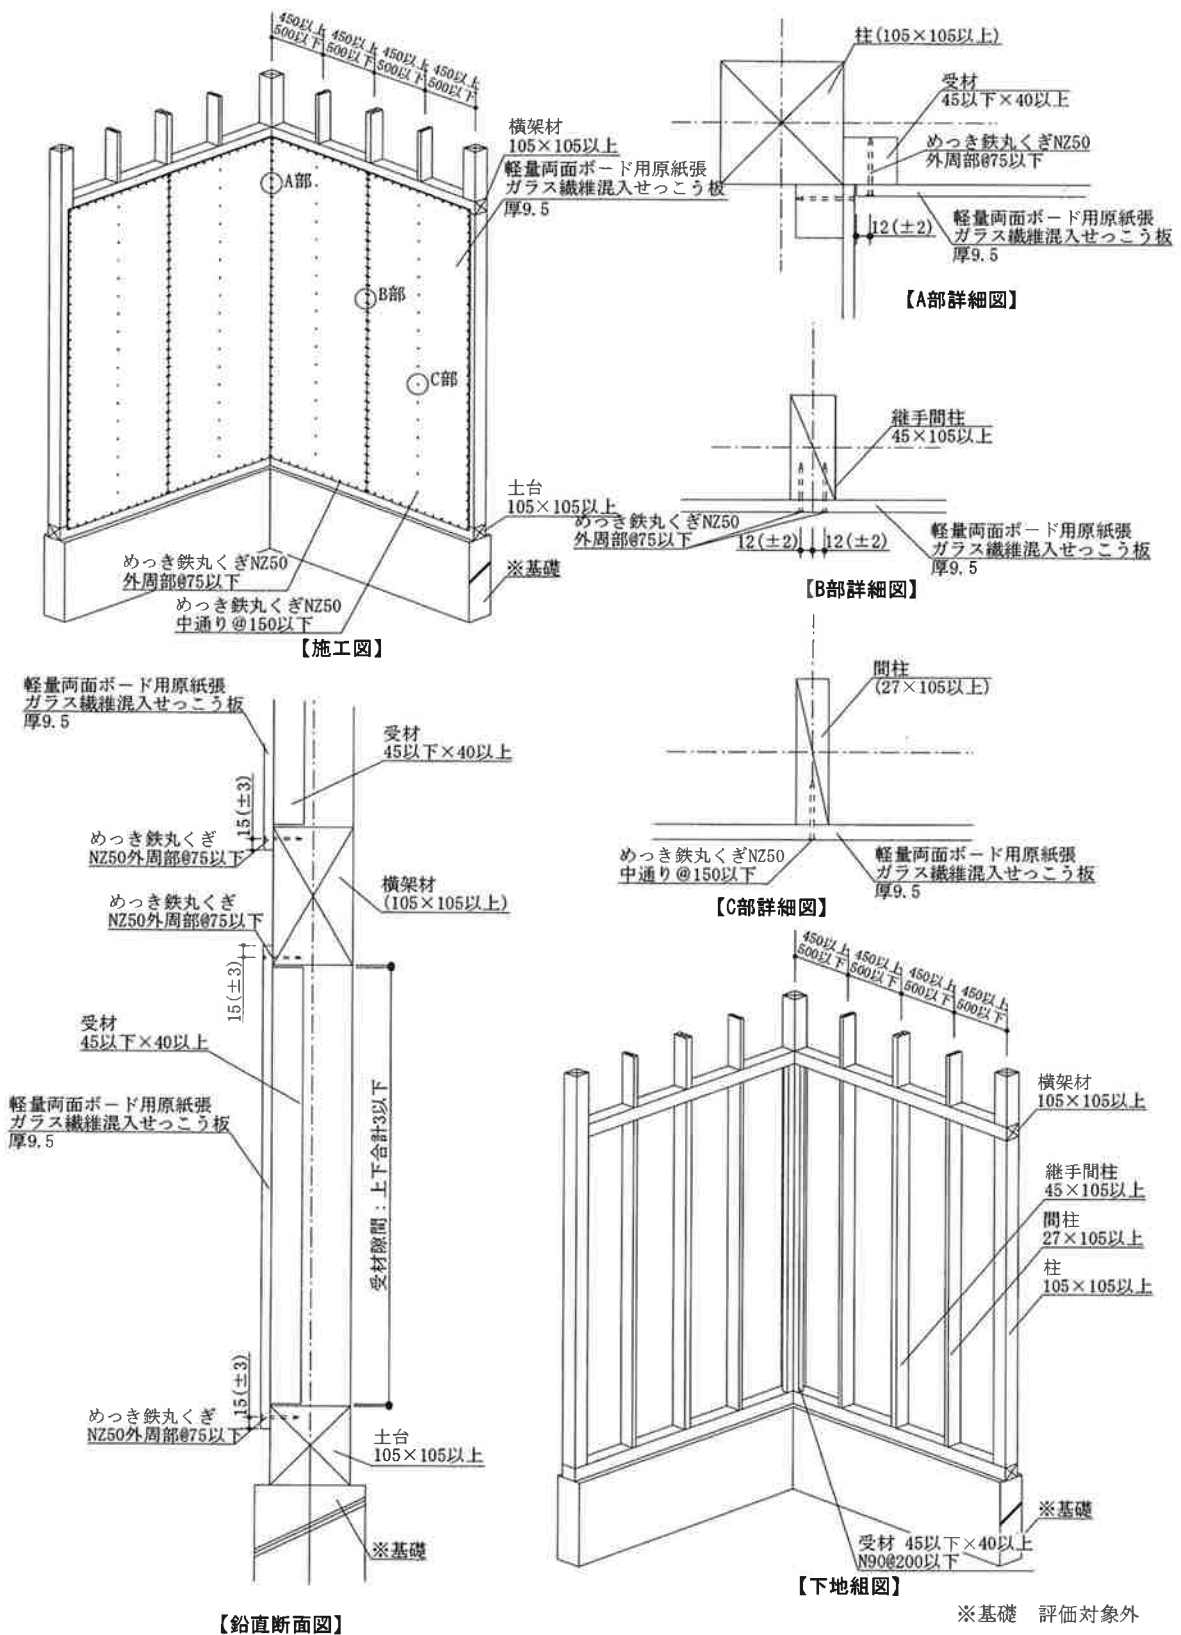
施工詳細図：1枚張りの場合 (寸法単位：mm)
